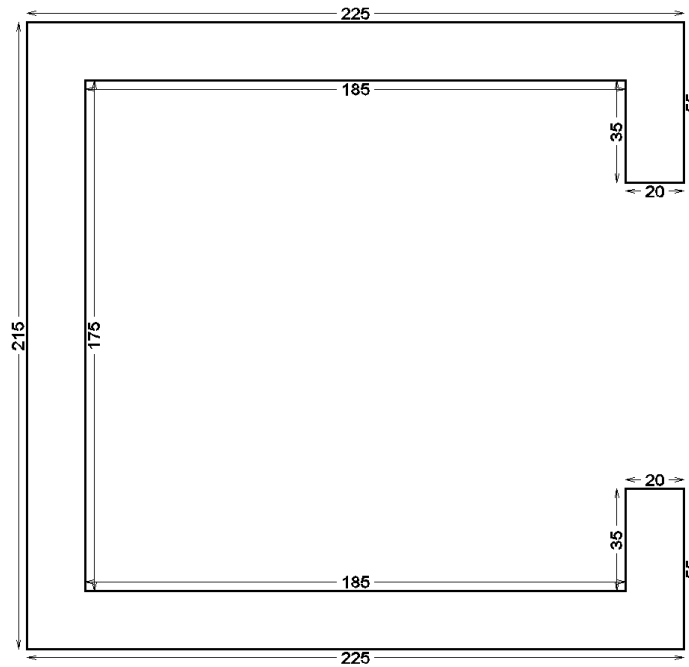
Geometria de Pantalla; Elaboración Propia
